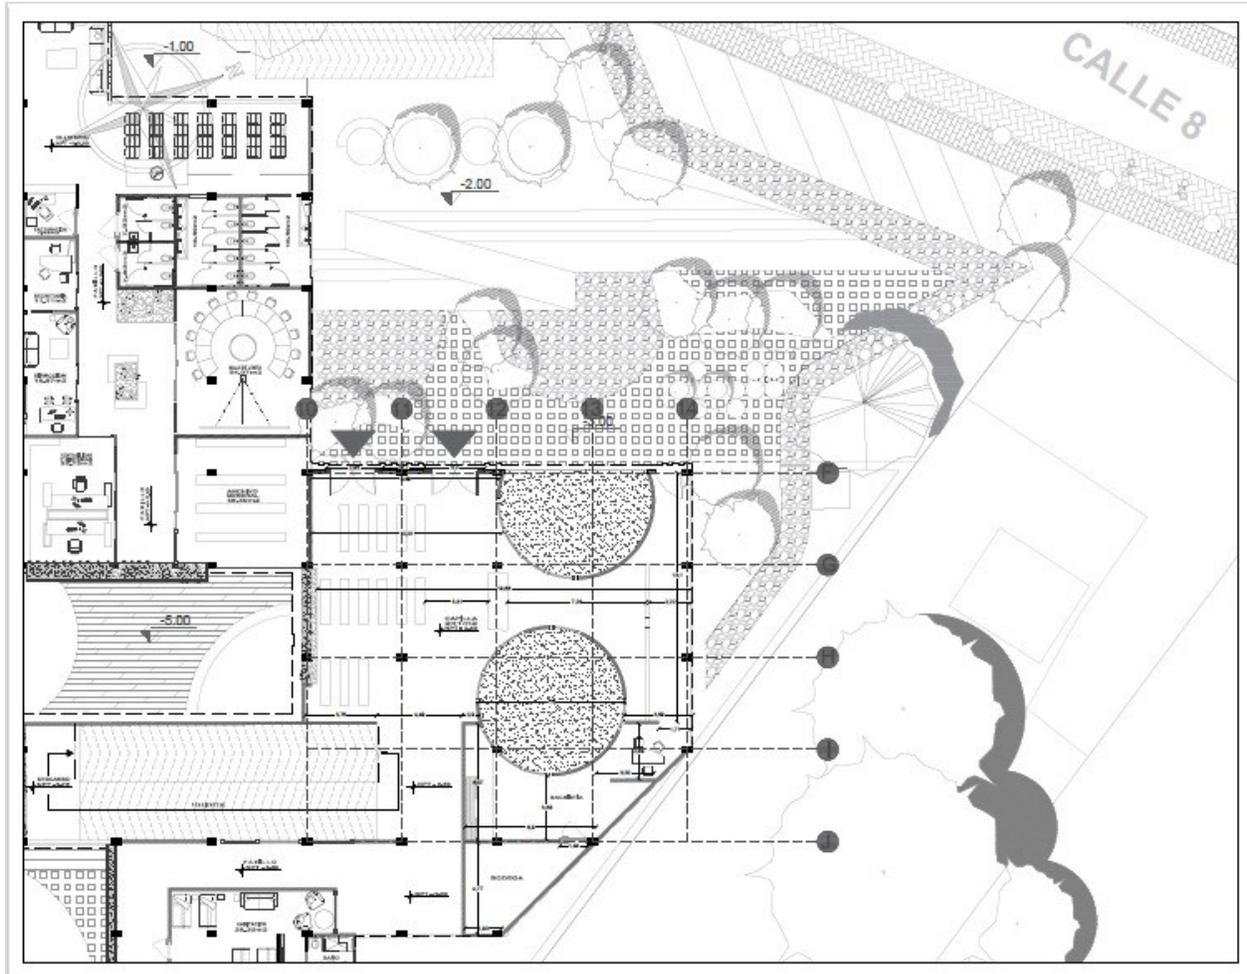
Planta 0 Edificación 4 Capilla (Rubiano, 2020)
